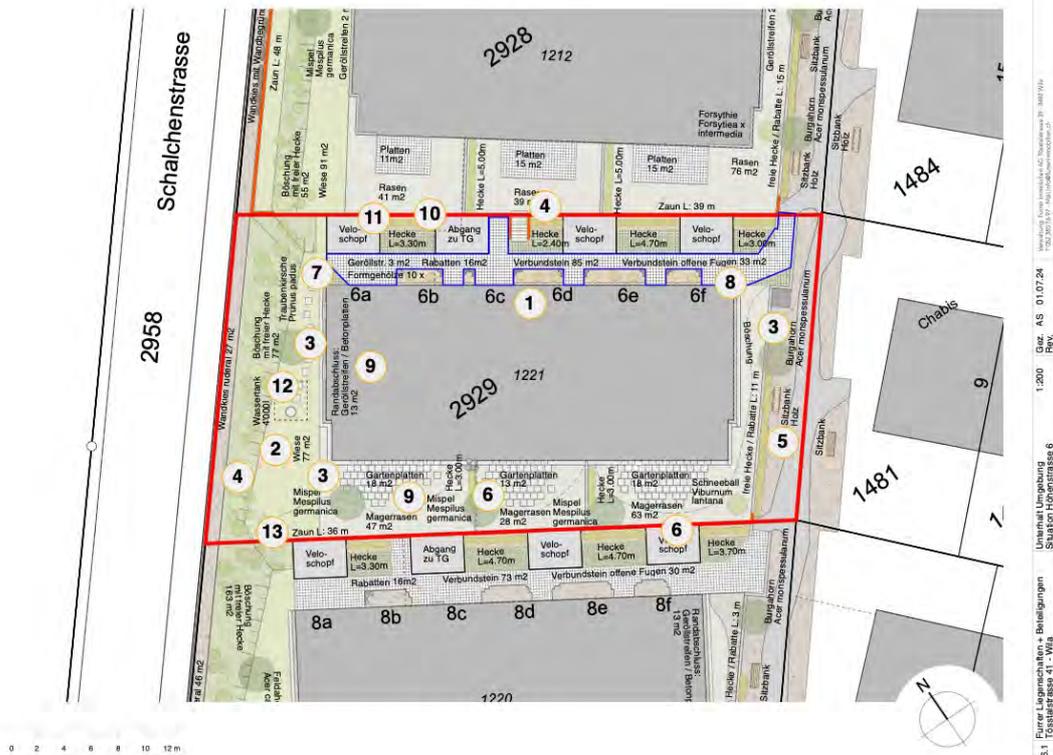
Grundriss Erdgeschoss mit Bearbeitungsperimeter und Flächenangaben
